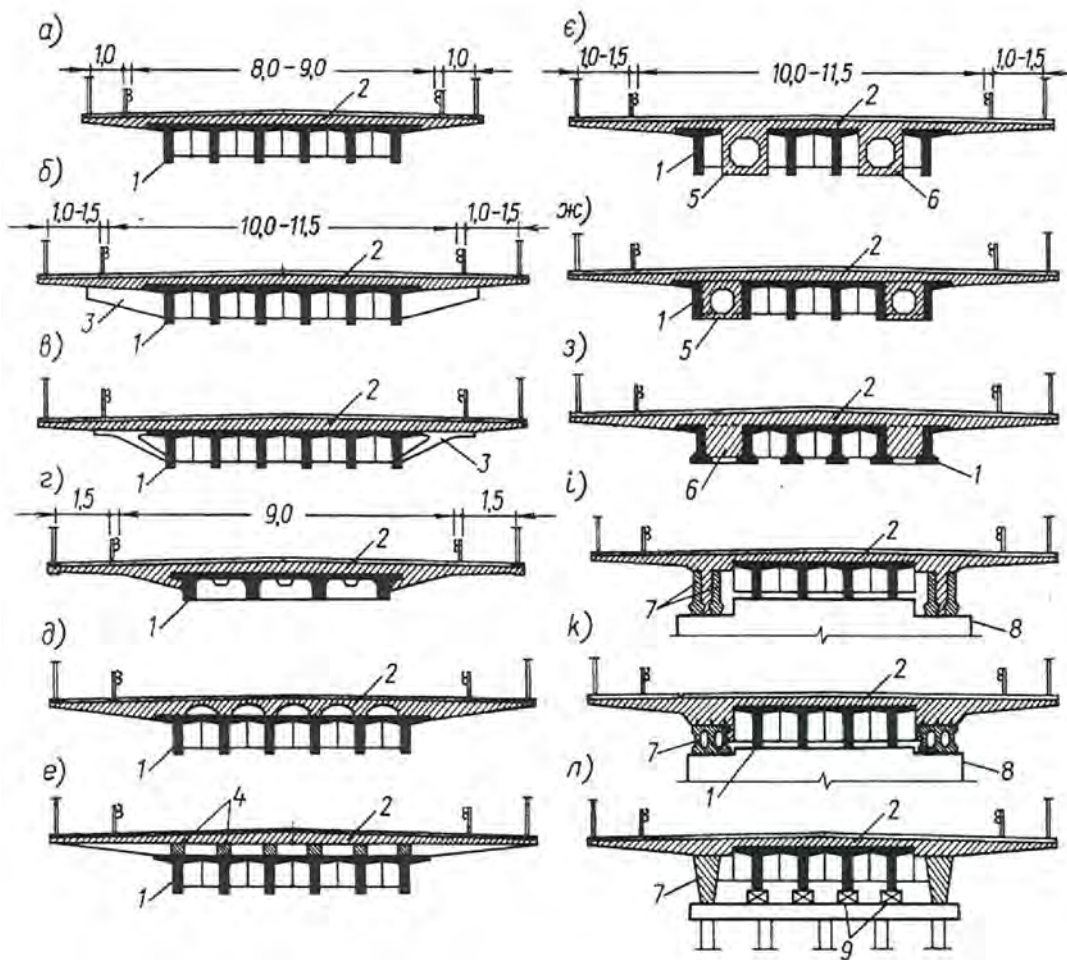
Розширення прольотних будов монолітною залізобетонною накладною плитою:
